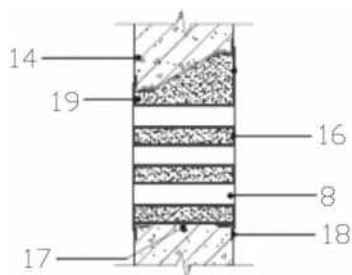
穿墙管群与混凝土侧墙之间连接结构示意图
